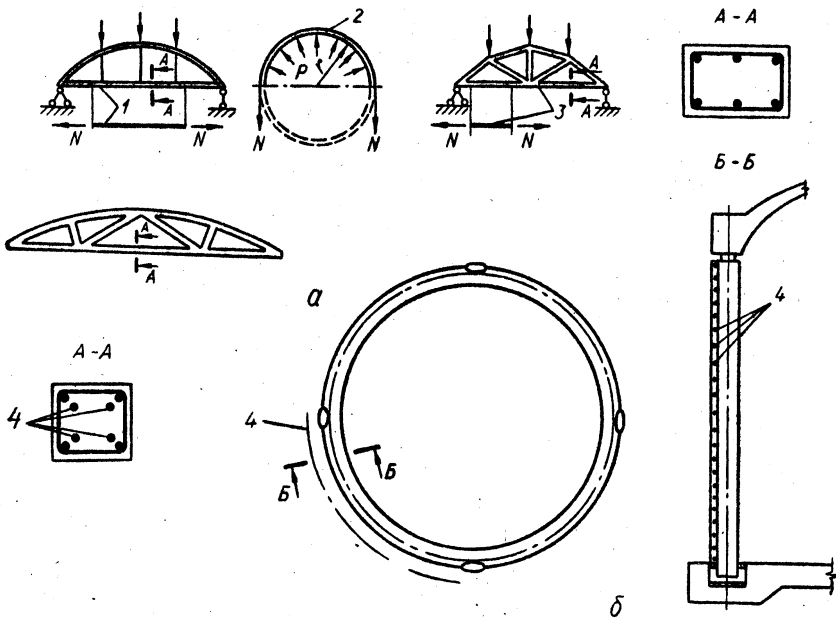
Центрально-розтягнуті елементи конструкцій: *a* – робота елементів на центральне розтягання; *б* – попередньо напружені елементи; 1 – стягель арки; 2 – стінка резервуара; 3 – нижній пояс ферми; 4 – напружена арматура
